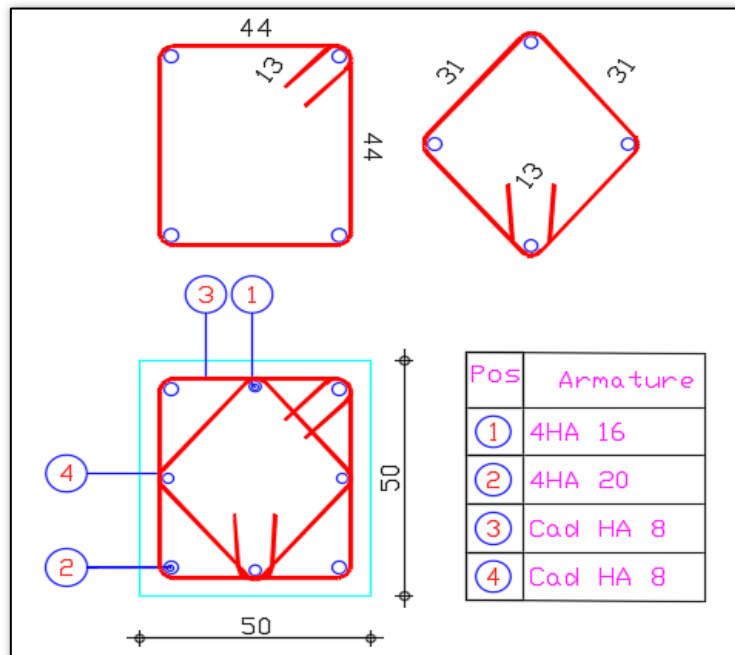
Schéma de ferrailage du tirant selon CBA.93.
